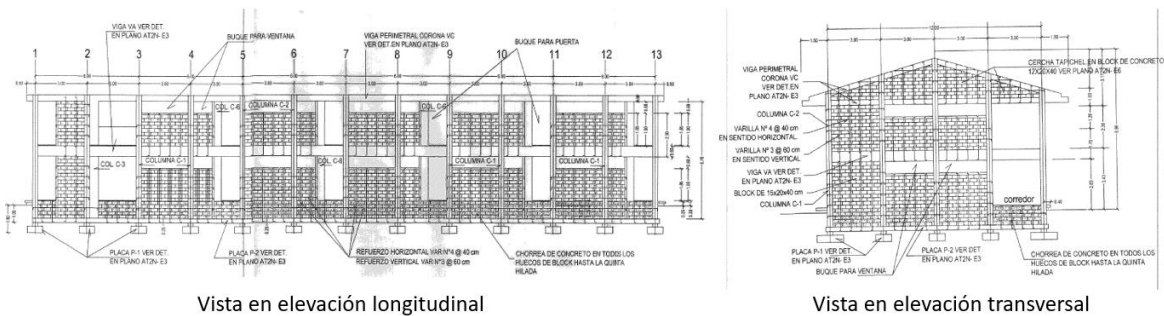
Vista en elevación longitudinal y transversal del primer nivel del edificio de aulas No.3 del CTP José María Zeledón Brenes, según planos constructivos
